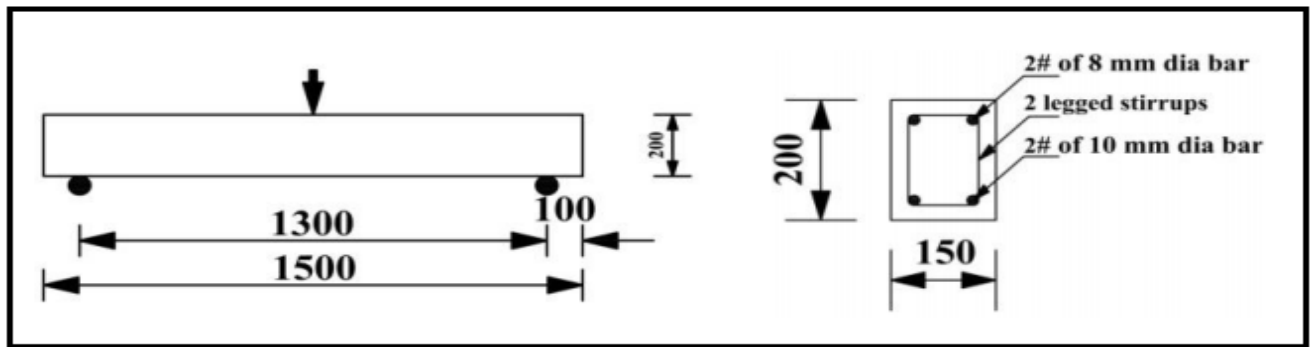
Dimensions et ferrailage des poutres testées [Sivakamasundari, S et al 2017].
